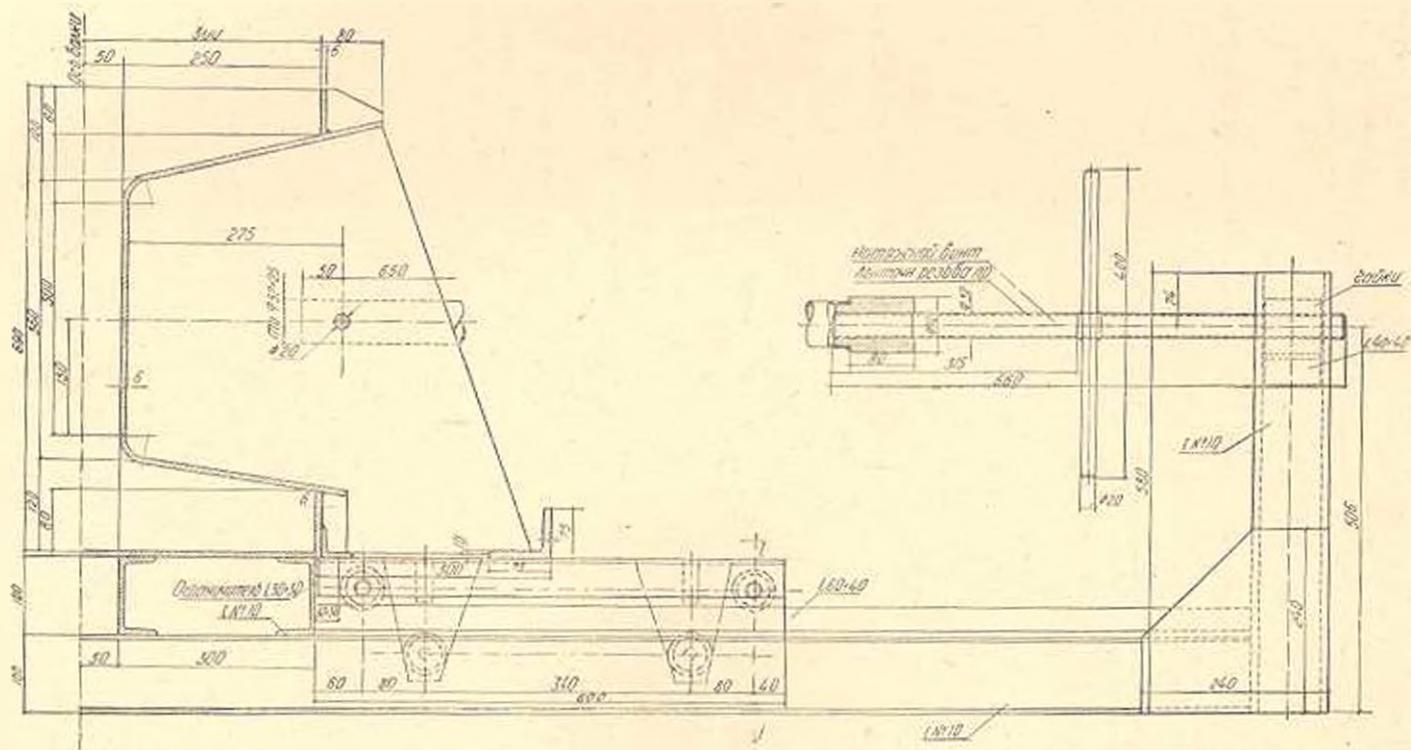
Металлическая форма для изготовления струйбетонных балок.
